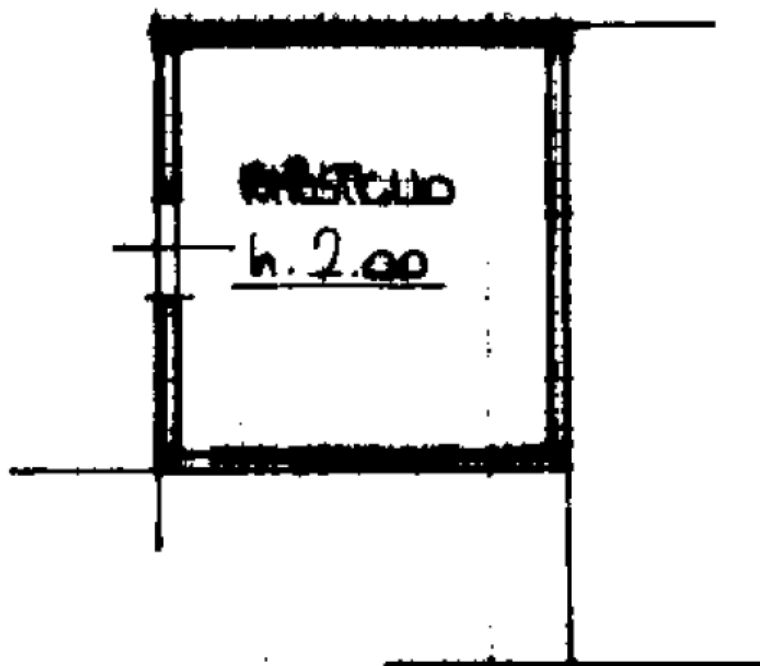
Pianta Piano Primo - Fabbricato 3 -Stralcio Planimetria Catastale - Fuori scala
